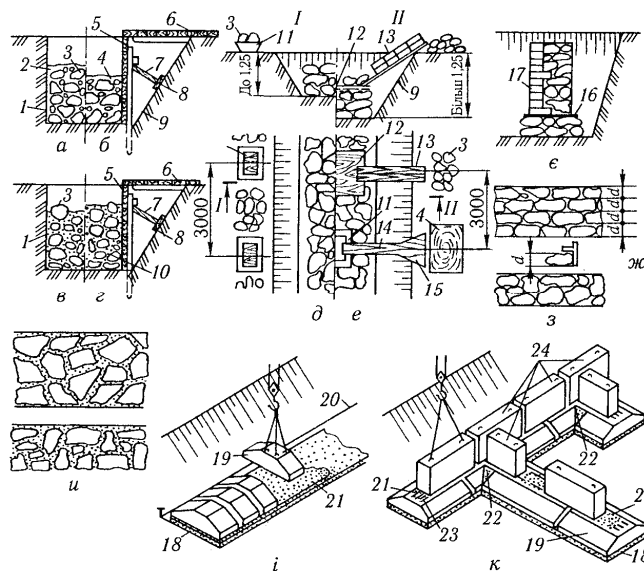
Зведення конструкцій підземної частини будівлі з бутового каменю і великих бетонних блоків:
